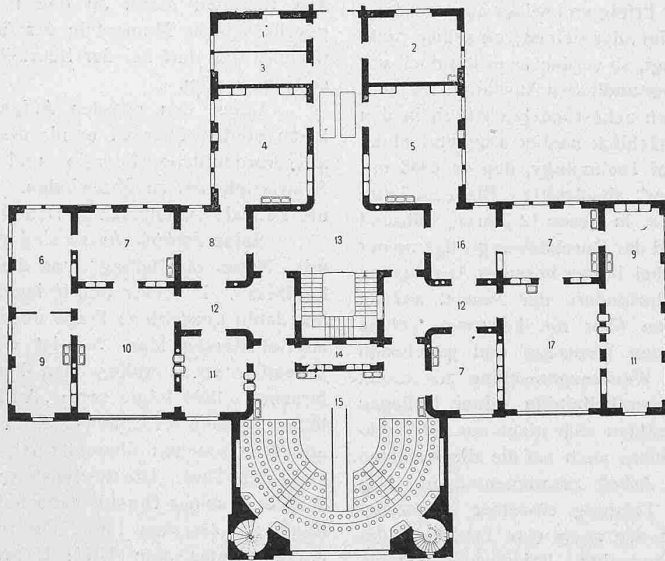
Grundriss vom II. Stock. — Masstab 1:500.
